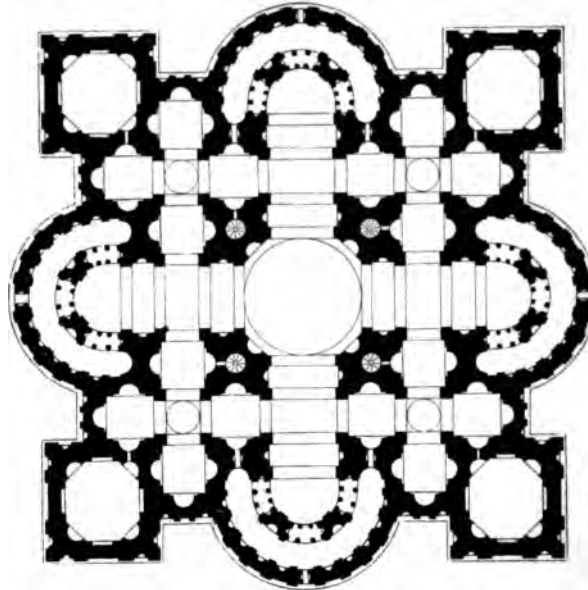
St. Peter. Peruzzis Grundriss.
